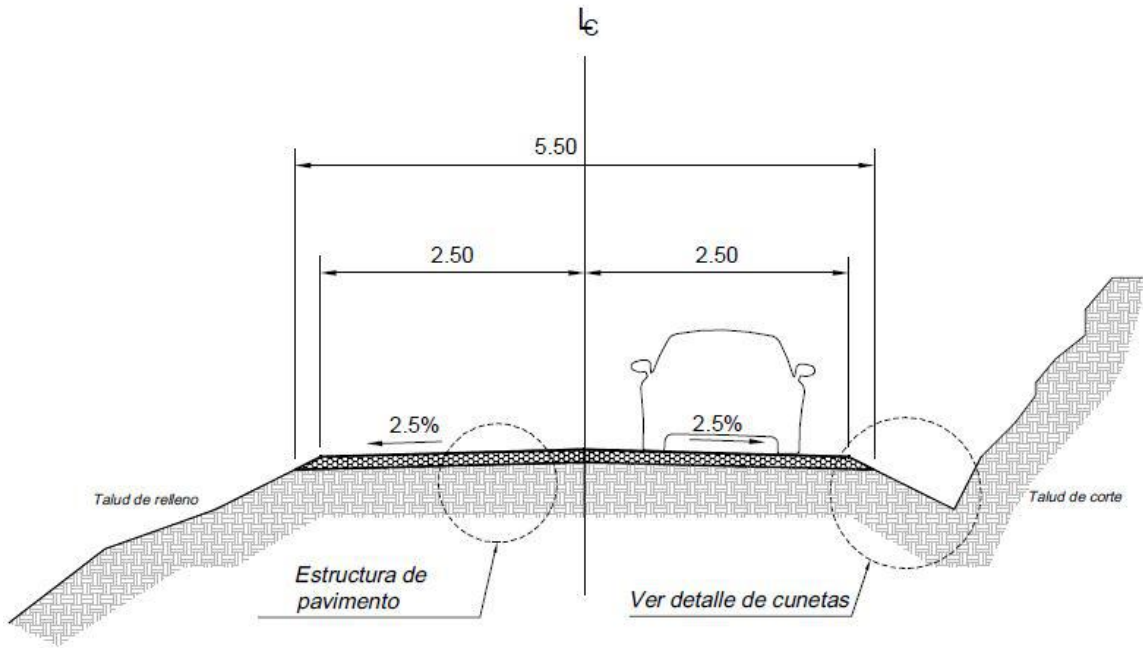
Sección Transversal Tramo 3, Est 3+773-6+000.
